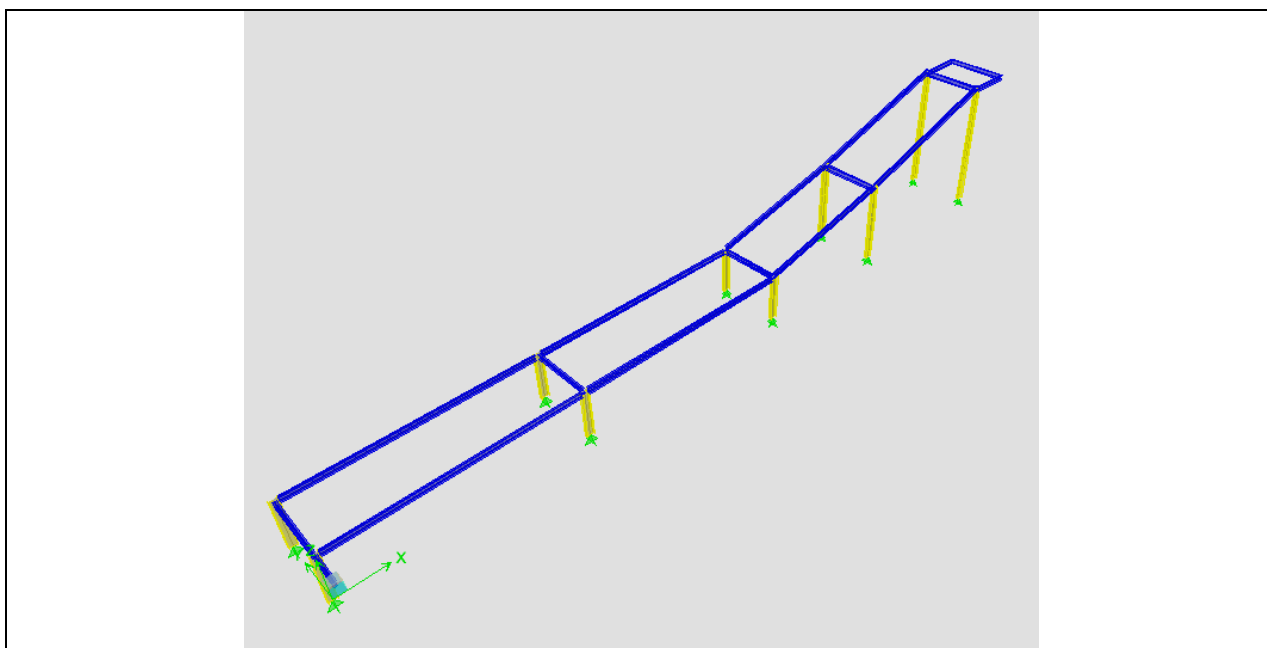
Modulo II, horno de fundición. Fuente: Propia.
